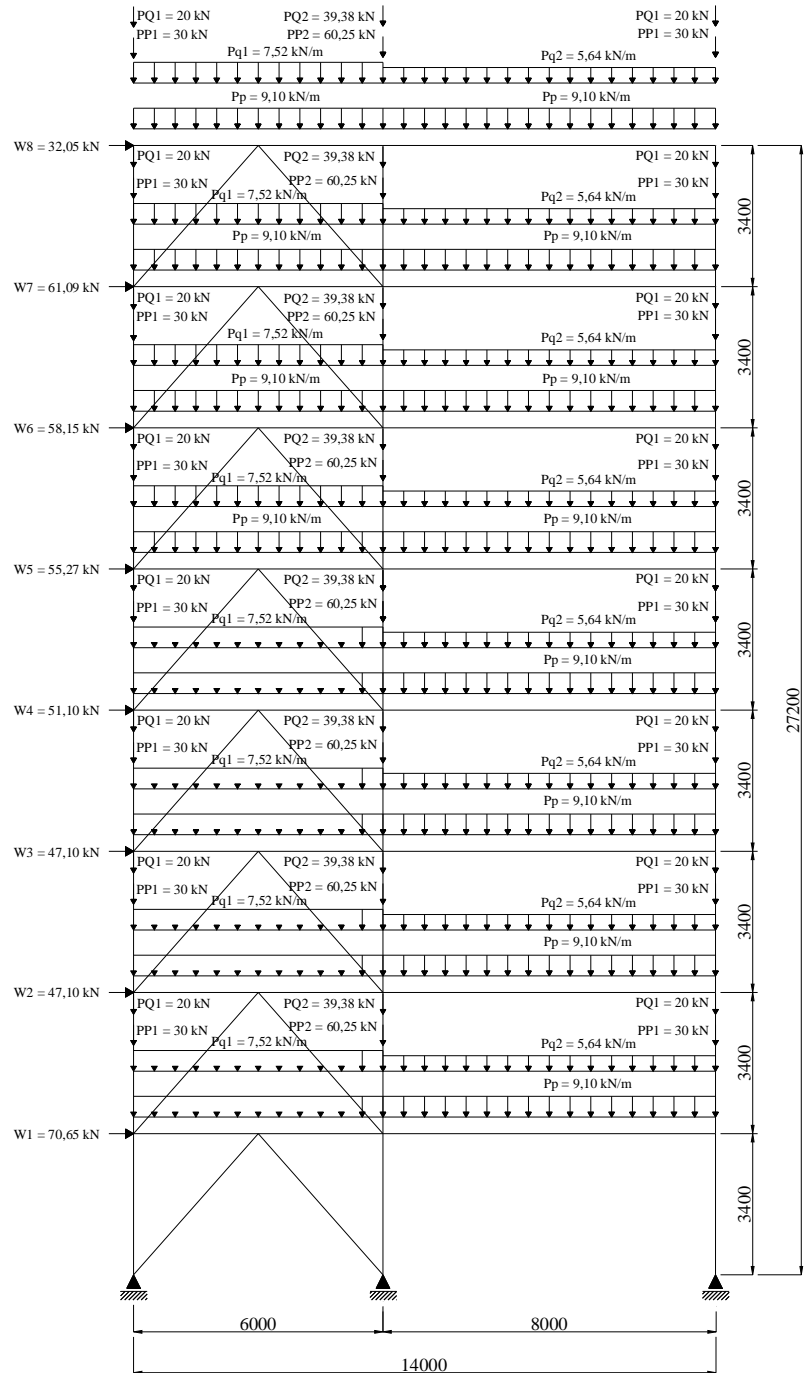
Pórtico contraventado de oito pavimentos (dimensões em milímetros e ações com valores característicos)
